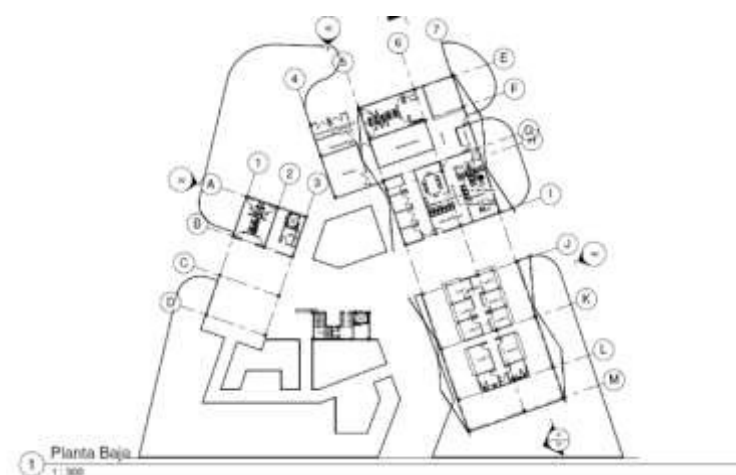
Planta baja Centro Cultural de Artes Plásticas. (2018)
